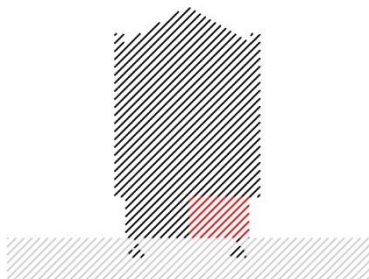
Planta 0 del edificio. Fuente: del autor.
